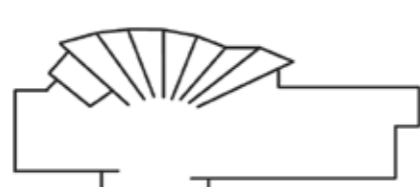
Planta esquemática da biblioteca Seinajoki City.
